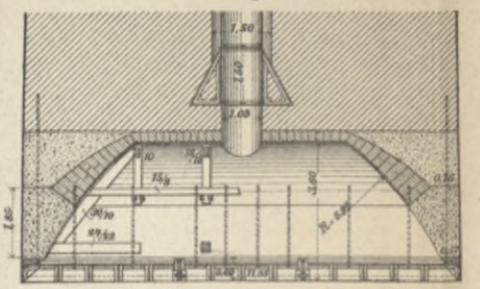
Gründung der Pfeiler. M. 1:200.
